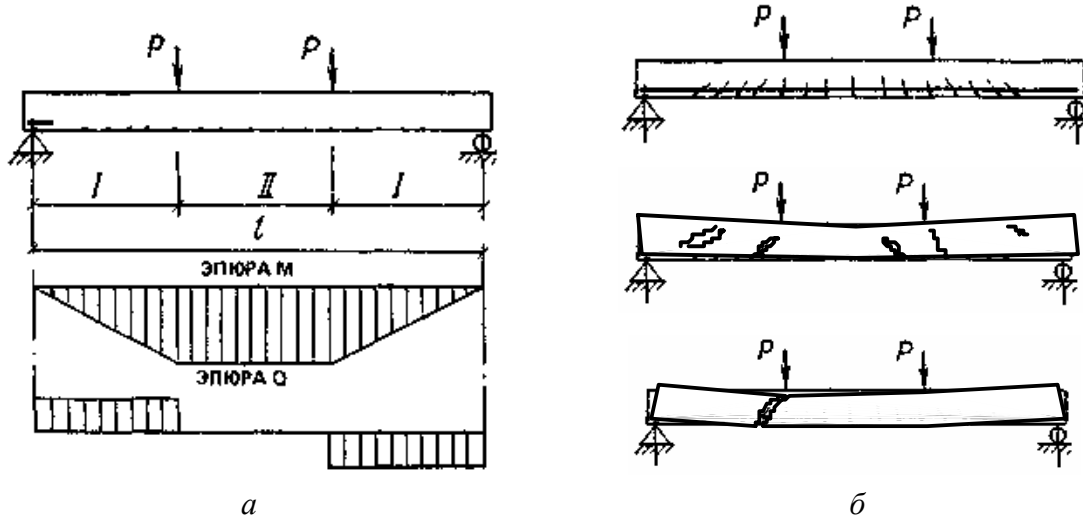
Можливі форми руйнування залізобетонної балки при згині:
